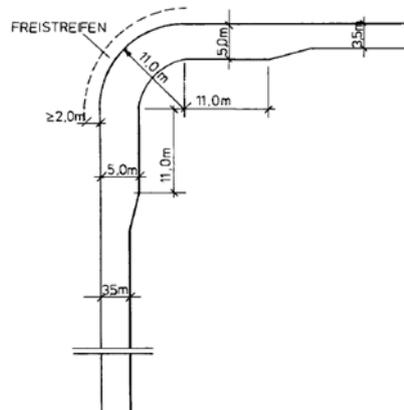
Radius Feuerwehrezufahrt lt. TRVB 134
